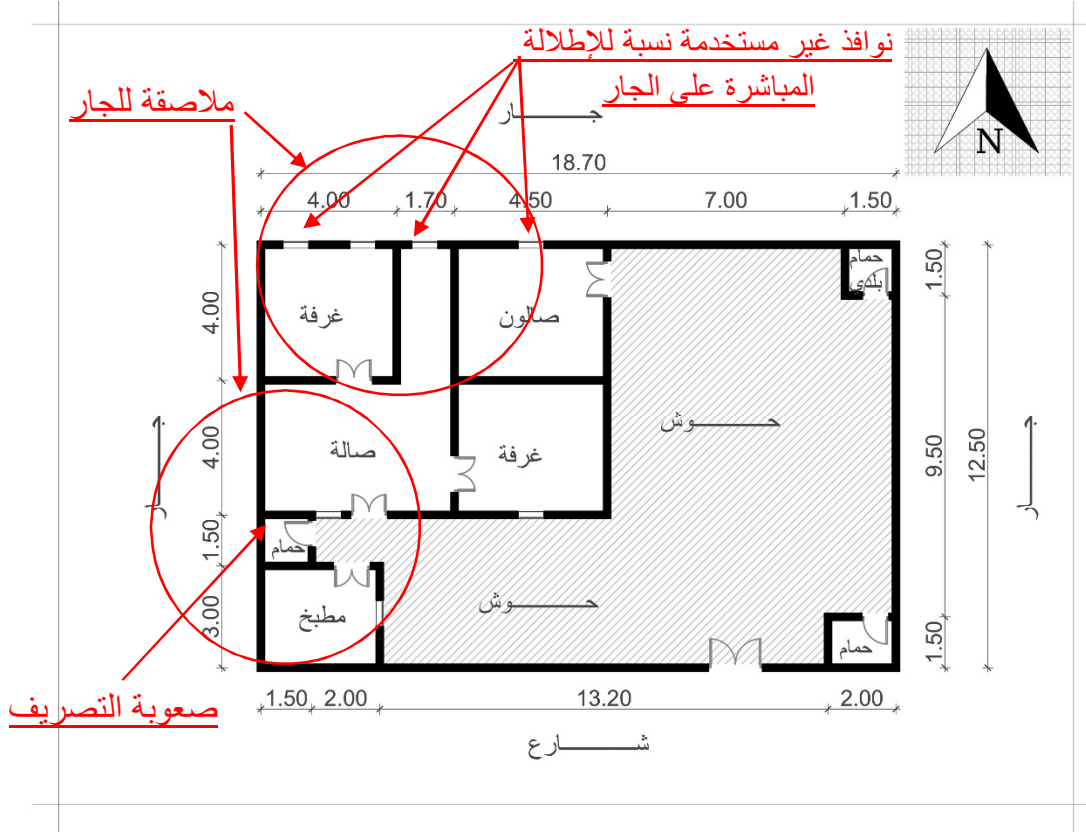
مسقط أفقي للدور الأول لحالة الدراسة الرابعة (المصدر: الباحثة)
